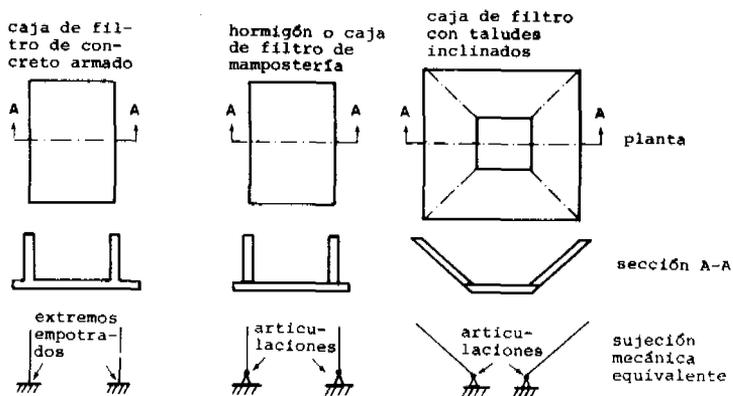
Diseño estructural de una caja de filtro y su equivalente mecánico
